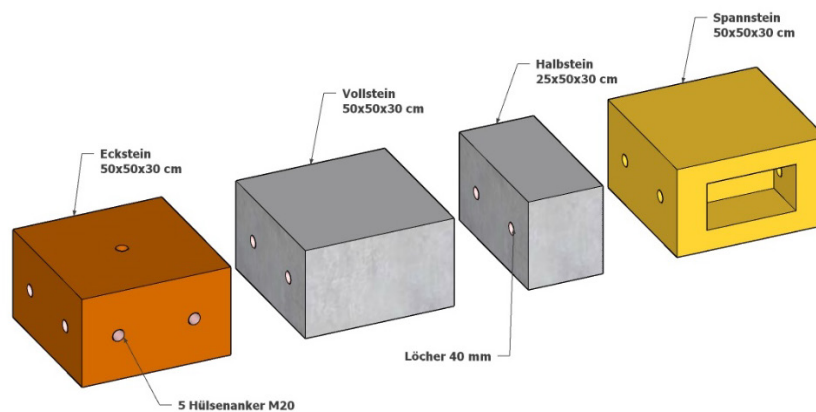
Fundamentbetonsteine für den Versuchsbau
